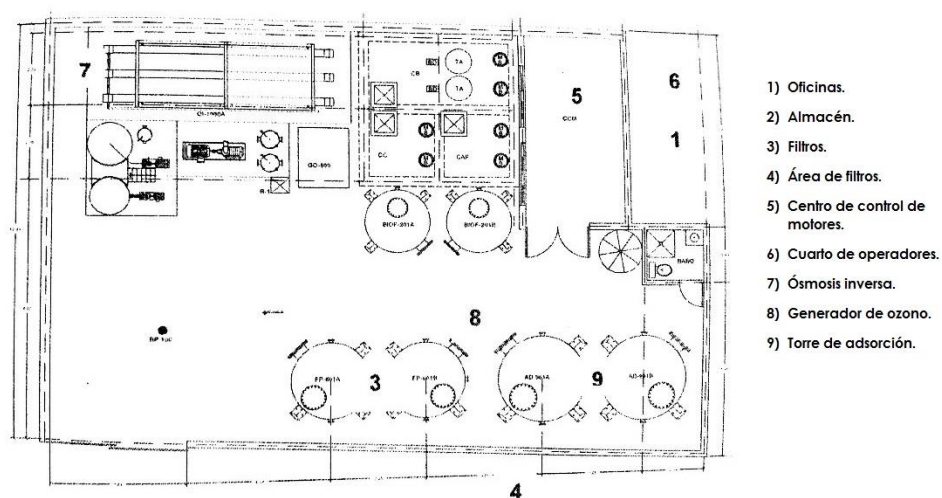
Vista en planta de la PP Santa Catarina 10
